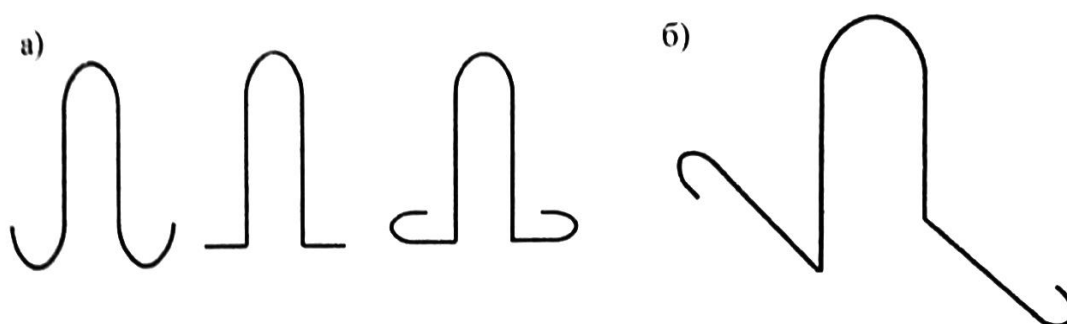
Монтажные петли: а) для ребристой плиты, б) для многопустотной плиты.
